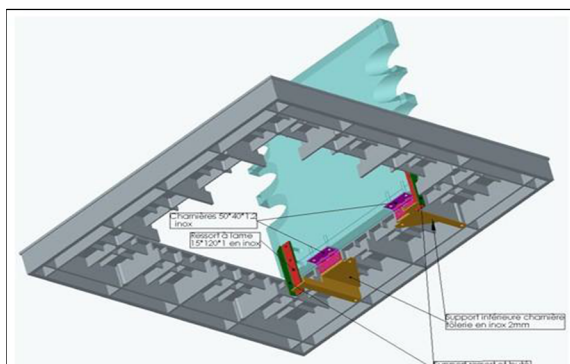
détail du plancher translucide. Source : PDF: Construire en acier.
